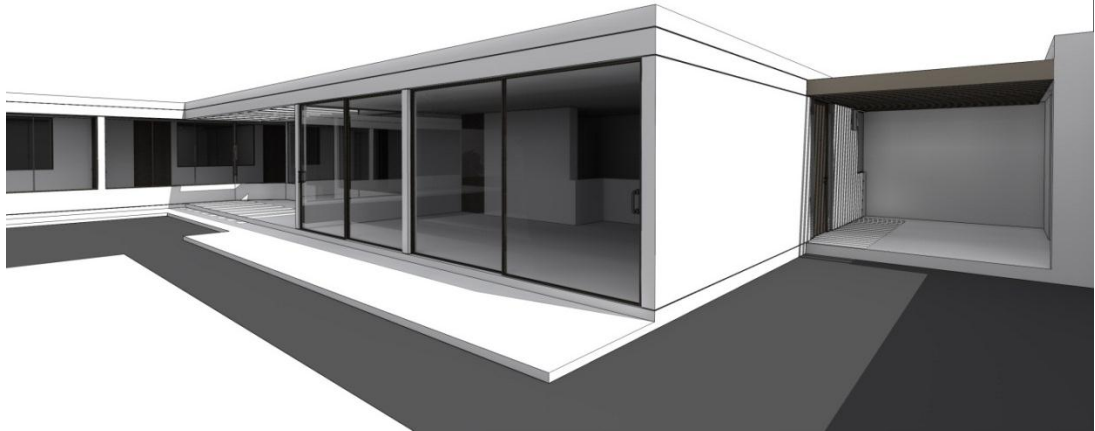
Vista fachadas interiores. Fuente: Elaboración propia.
